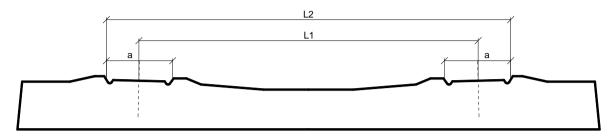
Железобетонная шпала со специально оформленными для скрепления подрельсовыми площадками – оформленные желоба и забетонированные дюбели для скреплений Vossloh
